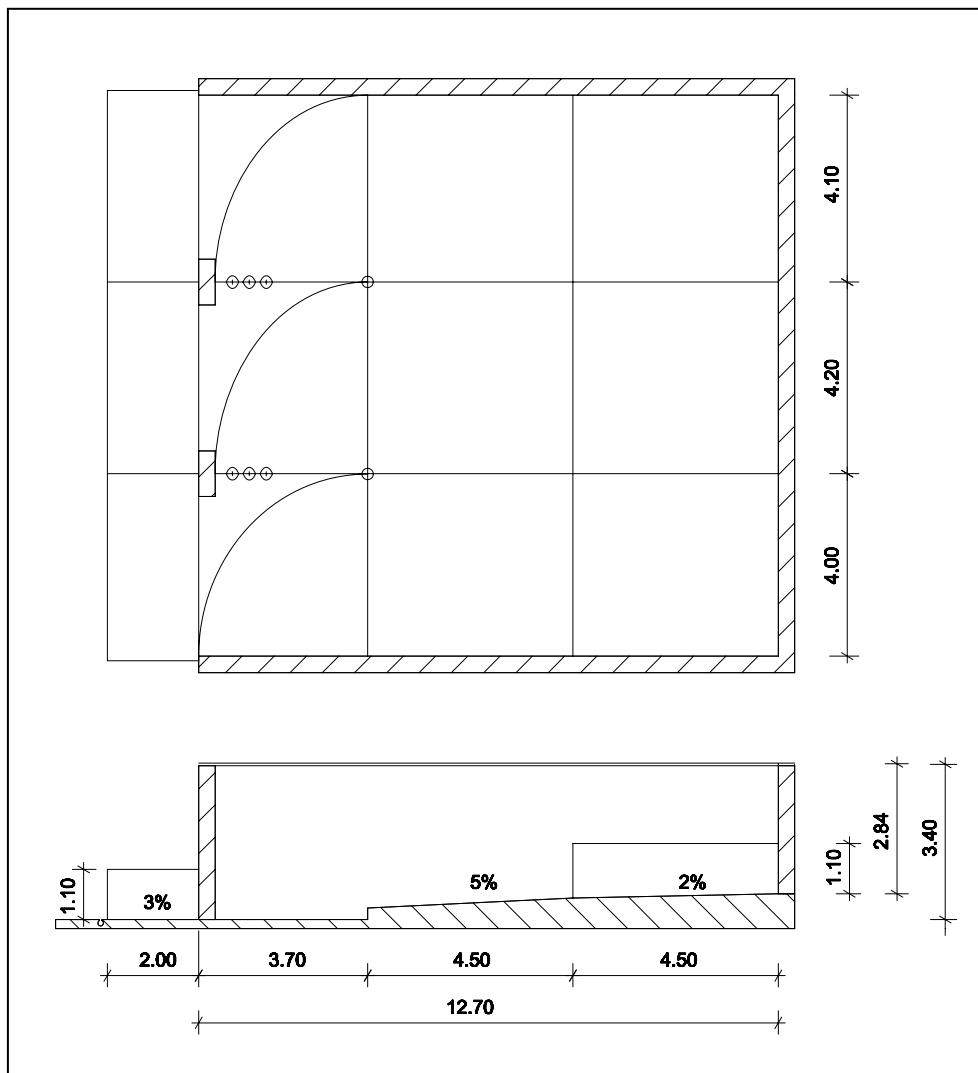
Skizze des 2000 zu einem Offenfrontstall für Mastschweine umgebauten Garagengebäudes (Grundriss)
